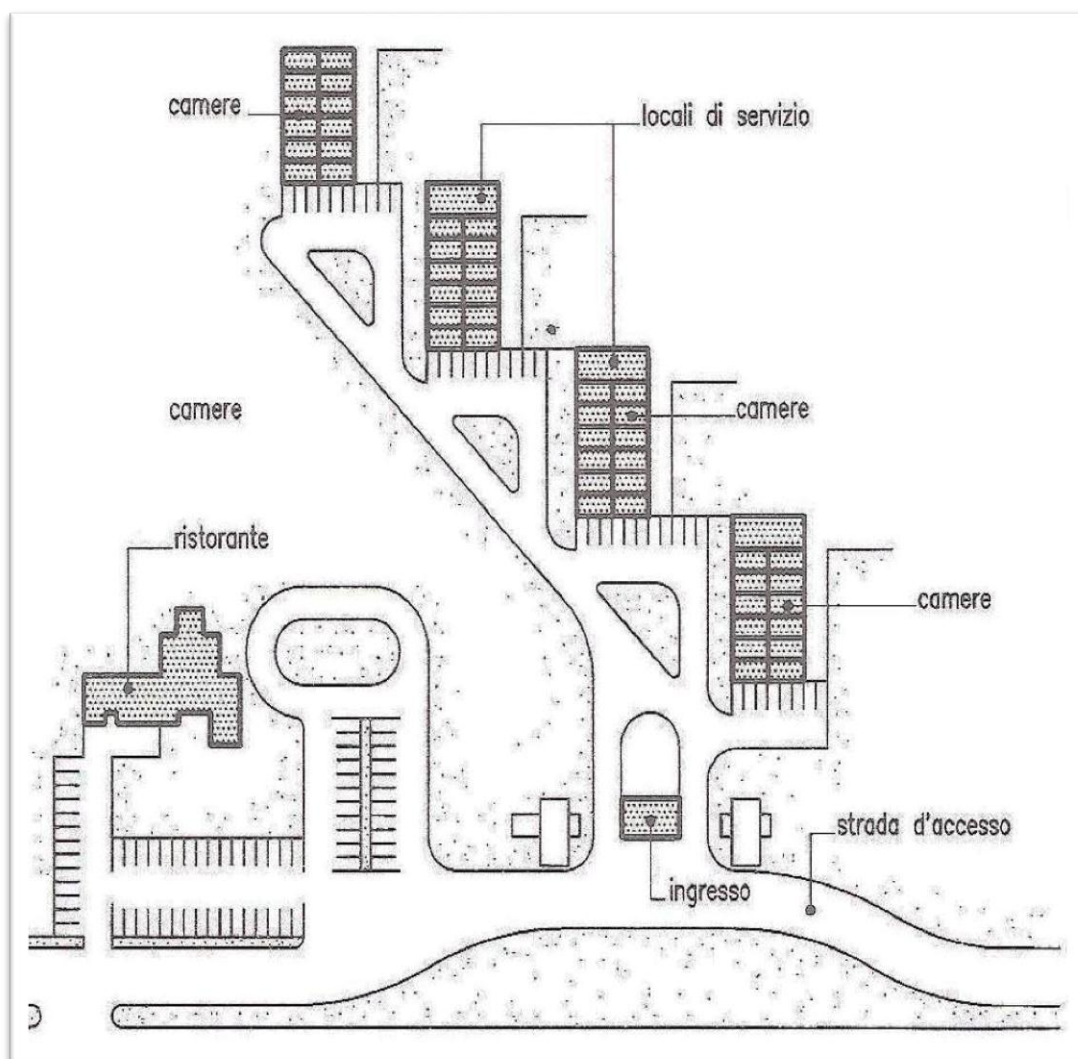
Motel, con aree di parcheggio sulla testa dei blocchi camere
